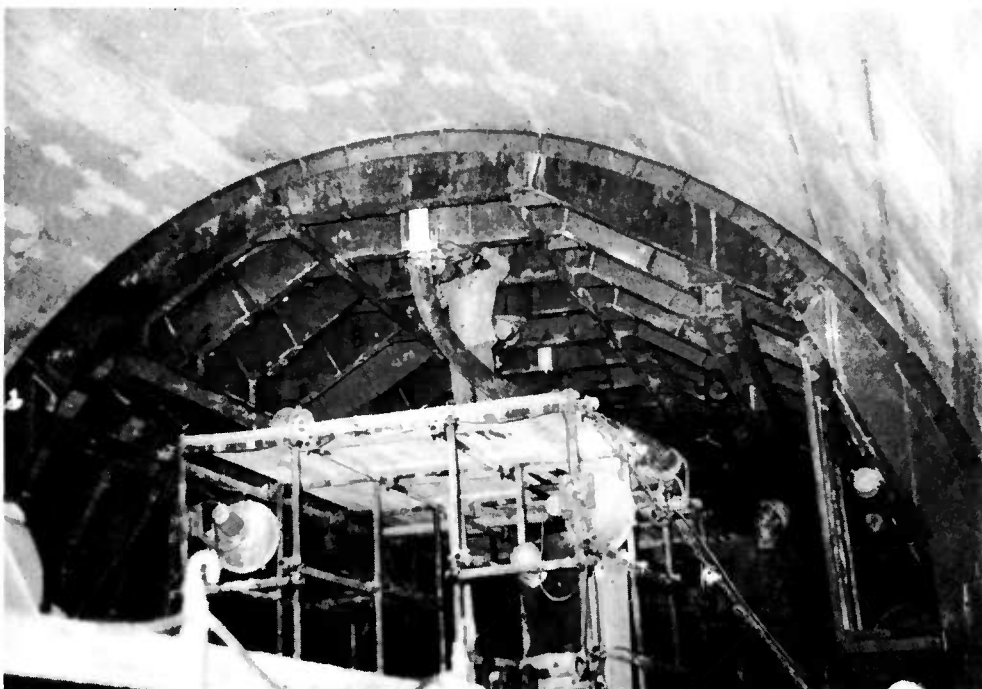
Tunnel de Buswiller - SNCF - Pipe de bétonnage.
